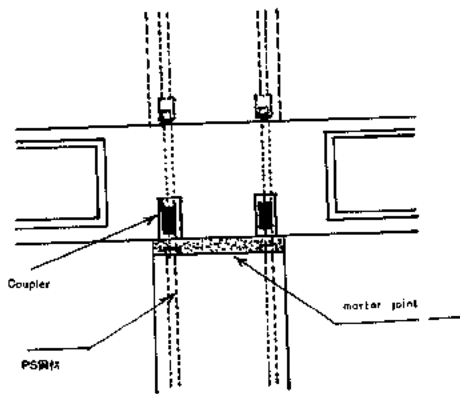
Precast 기둥과 Precast보와의 圧着接合法
